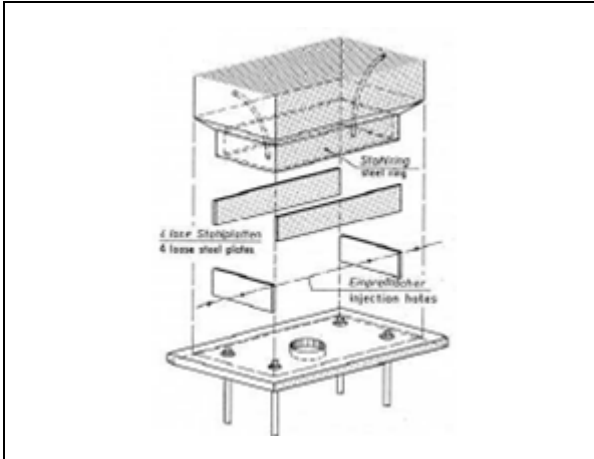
Ligação por soldadura a chapa (Stupré, 1981)
